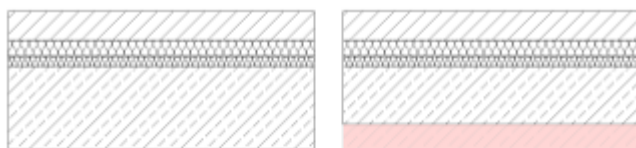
Abweichende Bauweise – Massivbau Geschossdecke
